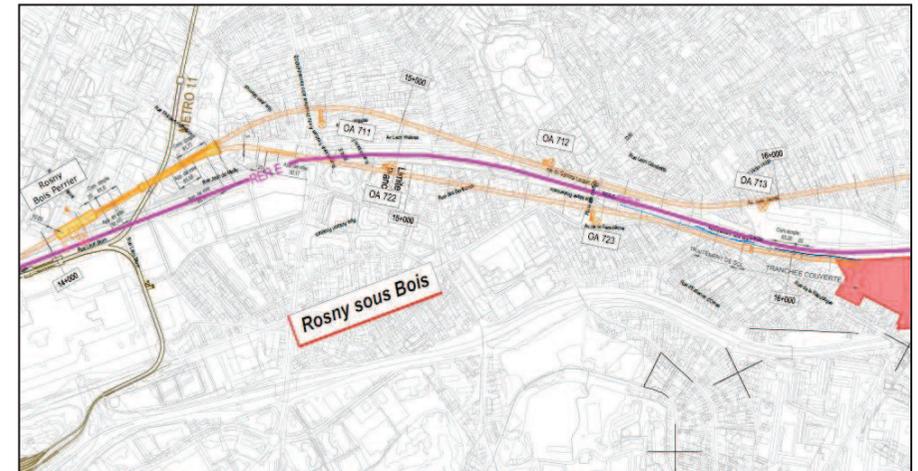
Tracé en plan du tunnel de liaison vers le site de la Garenne
